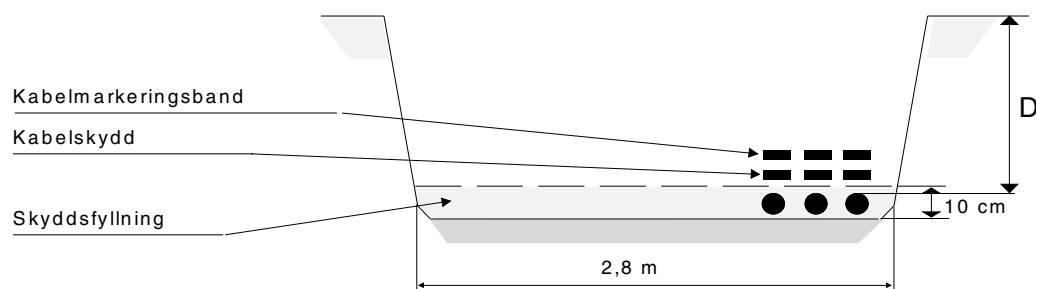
Placering av kabelskydd och kabelmarkeringaband för slinga enligt bild 62a, sedd från sidan
